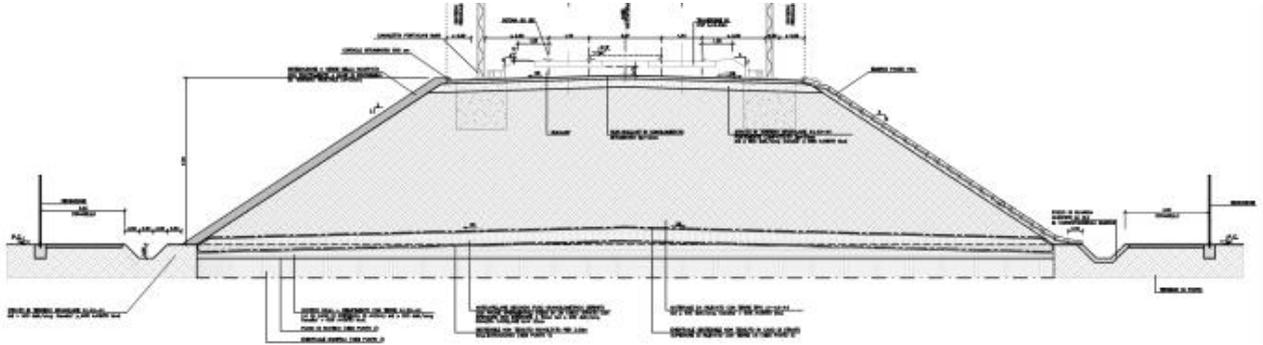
Sezione tipo rilevato doppio binario nuova sede
